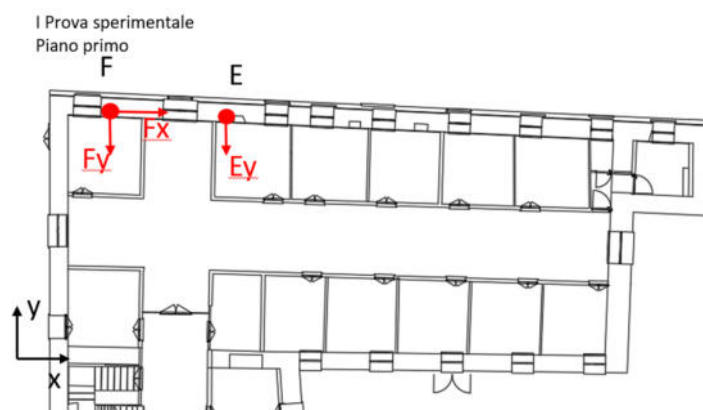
Disposizione degli accelerometri nel piano primo dell'edificio
